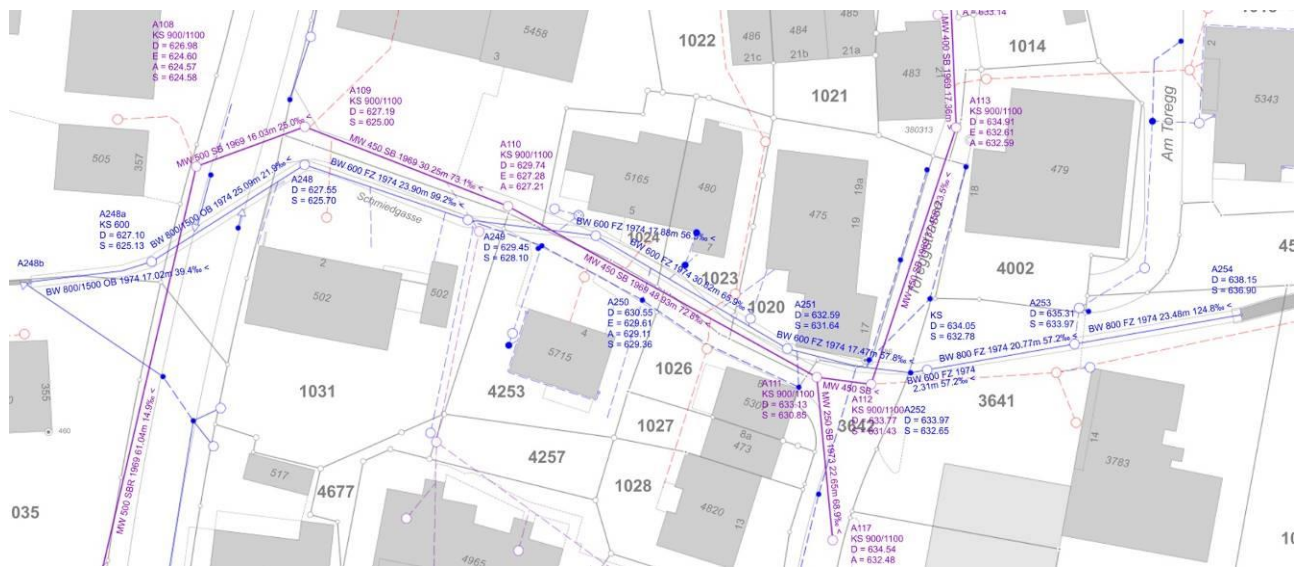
; Ausschnitt aus Abwasser Werkplan geoportal.ch (ohne Massstab)
